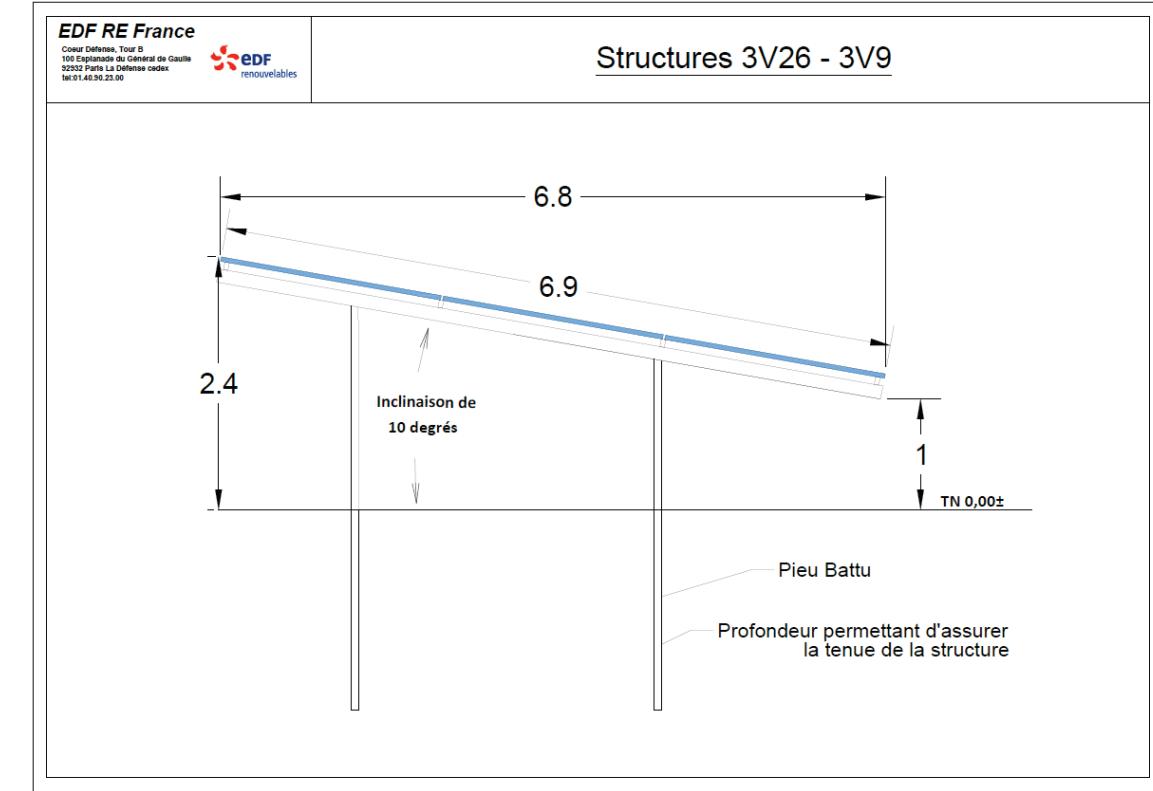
Coupe des pieux battus (source : EDF Renouvelables)
